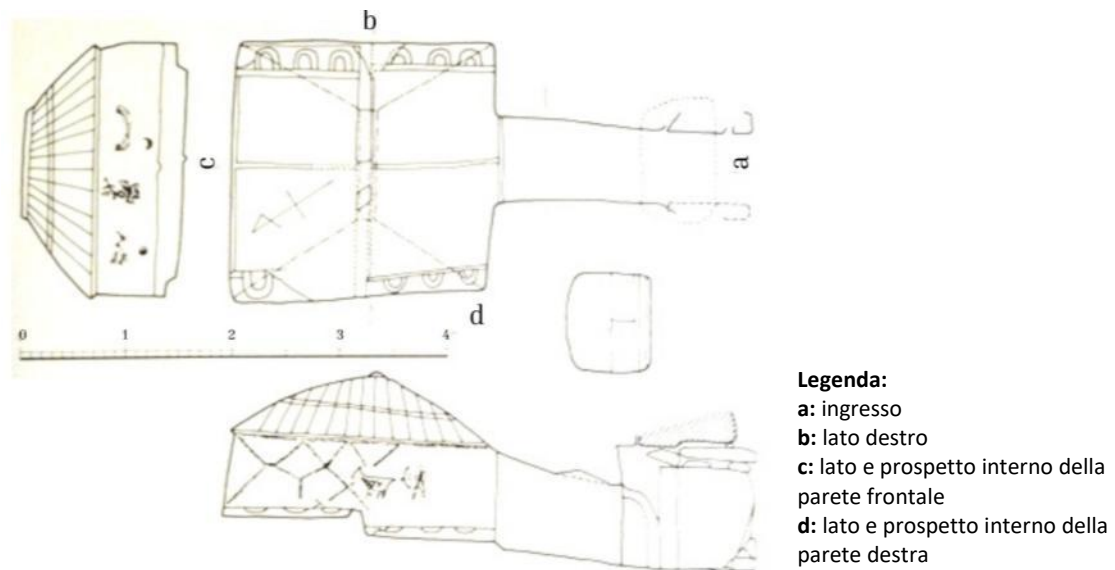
pianta e prospetto interno della tomba di Seto n. 14
